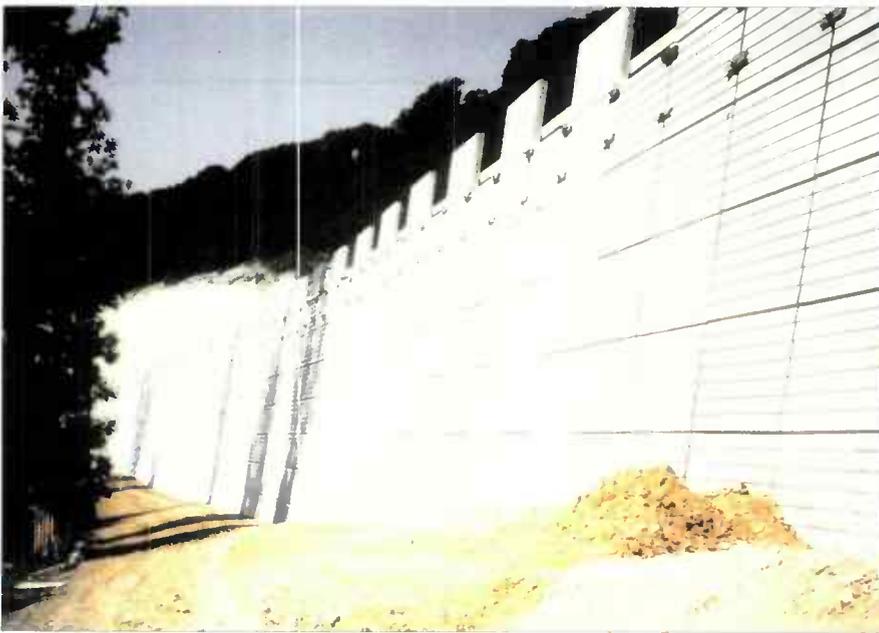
Parement à prédominance de lignes horizontales et verticales
